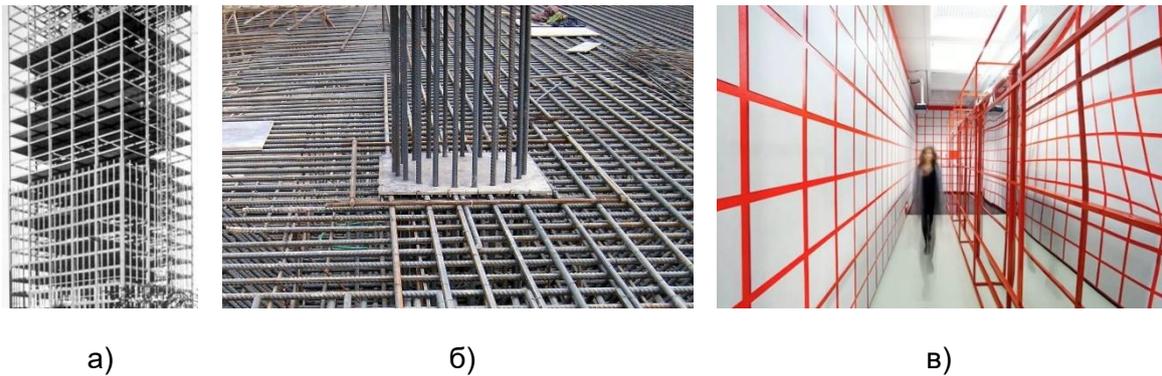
Сетка в основе пространственной структуры, конструкции и инженерного оборудования современного здания: а) каркас и фасад высотного здания; б) армирование перекрытия; в) система электромагнитной защиты – «клетка Фарадея»
